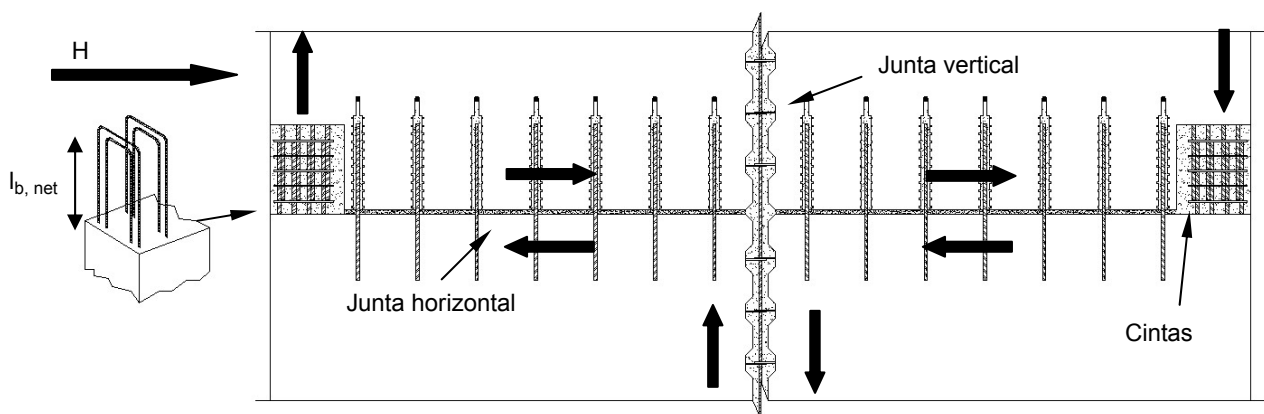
Ligação vertical e horizontal entre painéis de parede
